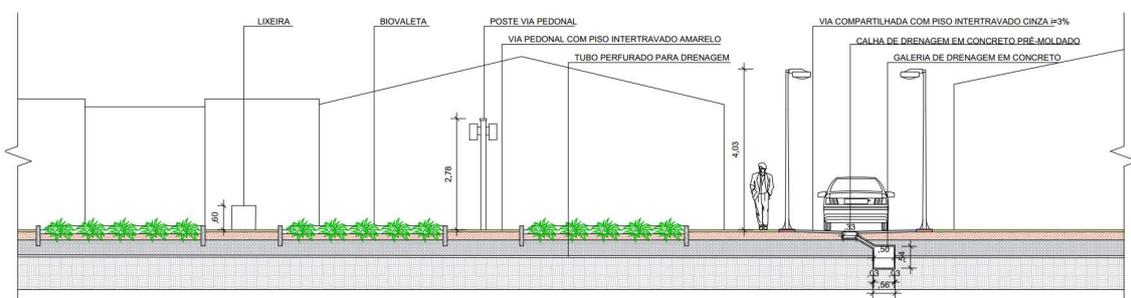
Corte do trecho 01. Fonte: Elaborado pelo autor.
